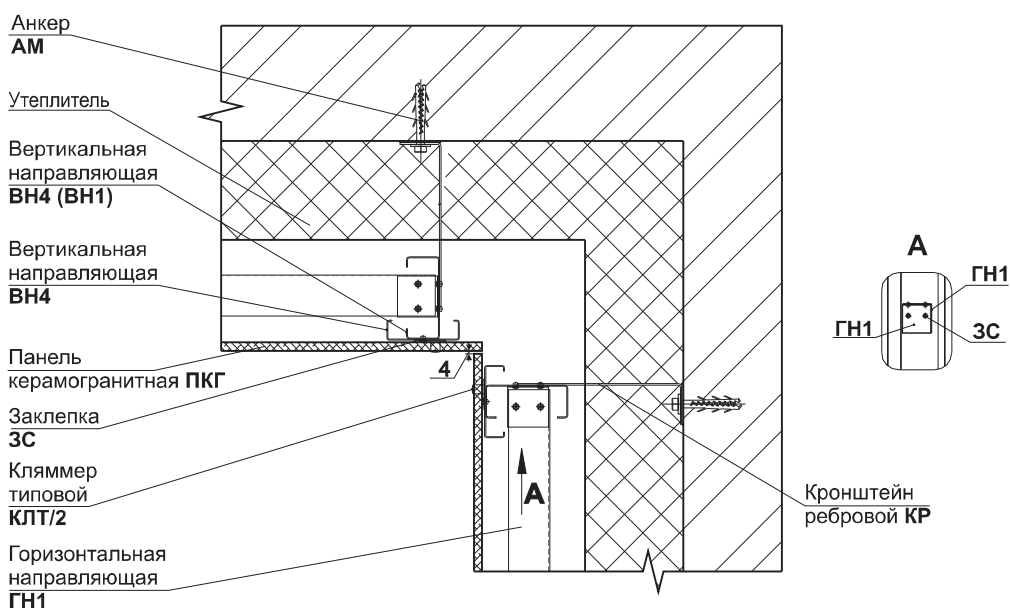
Узел облицовки внутреннего угла. Вариант крепления системы к междуэтажным перекрытиям.
